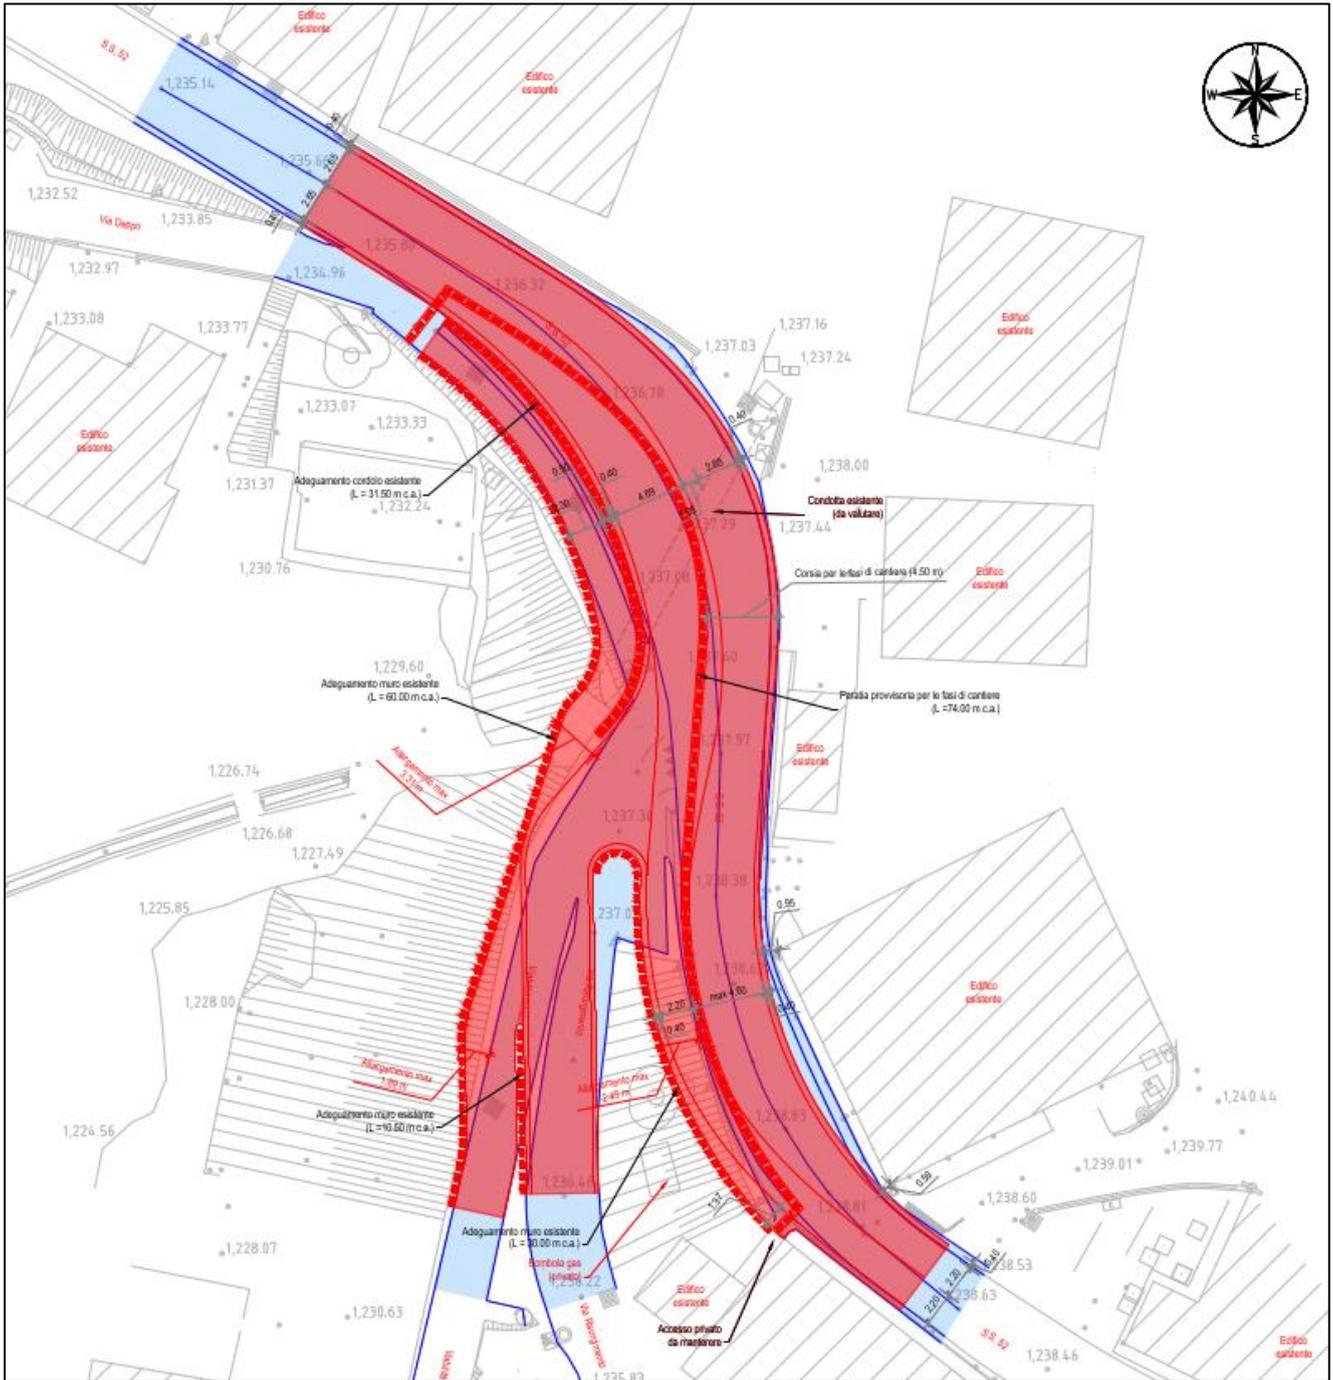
stralcio planimetrico comparativo stato di fatto e stato di progetto
